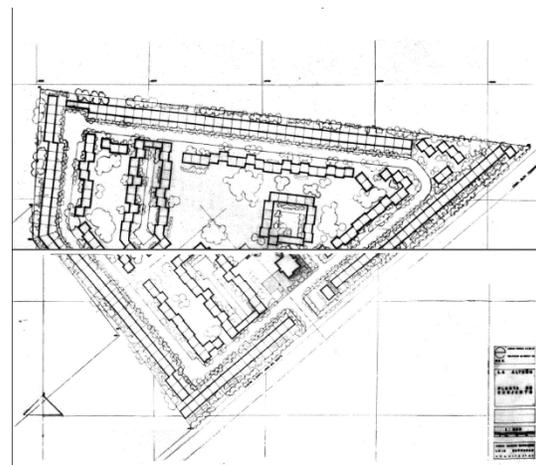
Planta de conjunto La Alteña. Fuente: Revista Arquitectos de México, No. 27.
